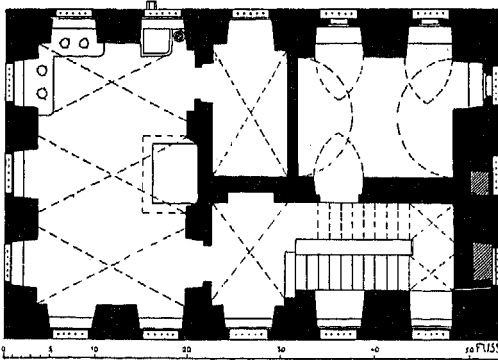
Holzhausense Oede; Grundriss des Keller-
